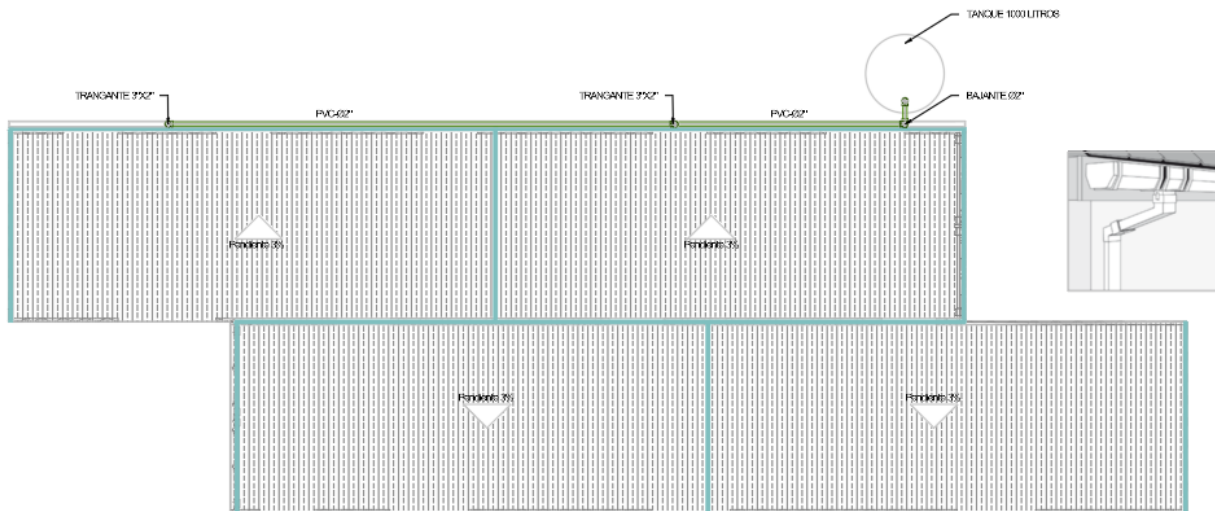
, Planta Diseño Agua lluvia, 2025-II, Wilson Lozano
